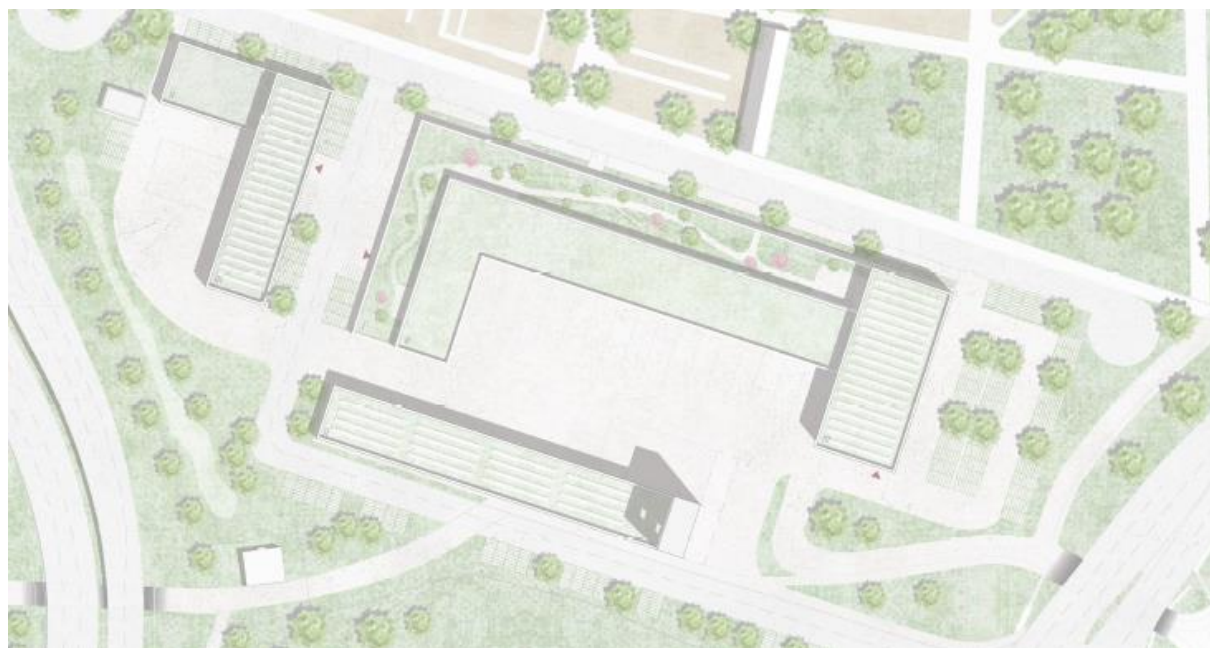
Lageplan ausgewählter Wettbewerbsentwurf (1. Platz)
